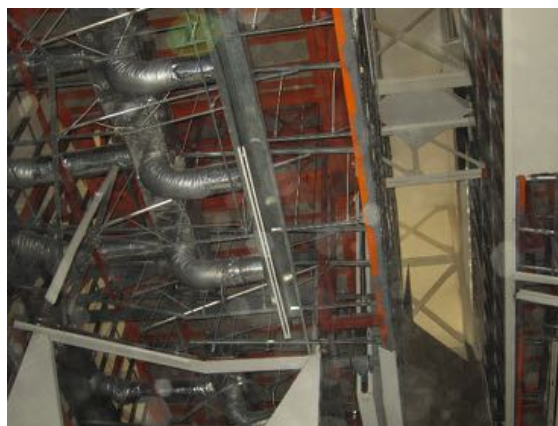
天井裏の状況 (天井脱落箇所)
